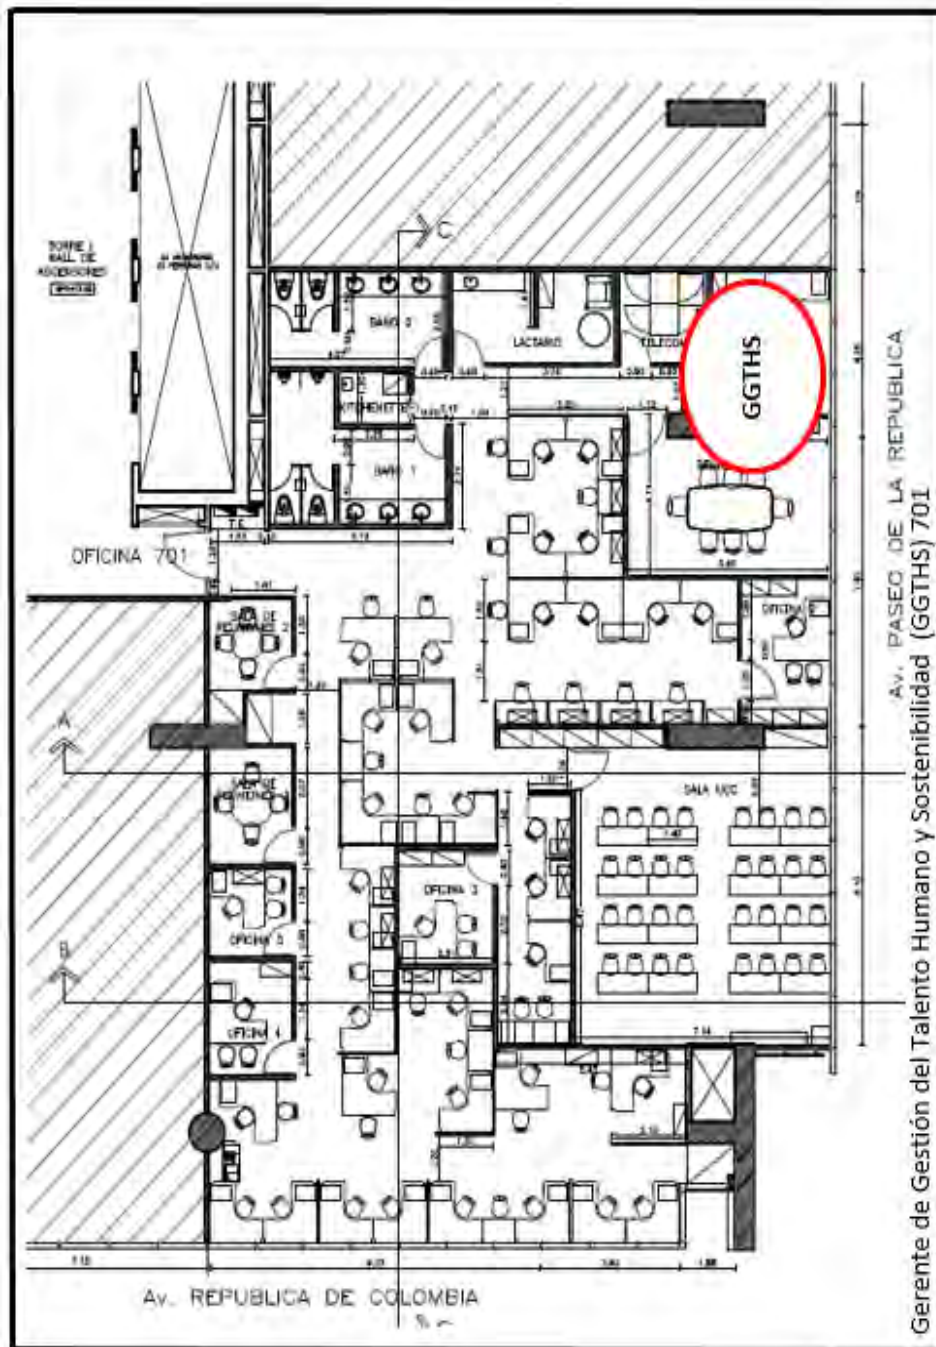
Vista panorámica de la distribución actual de planta del 7mo piso, un área de oficinas de COSAPI.
